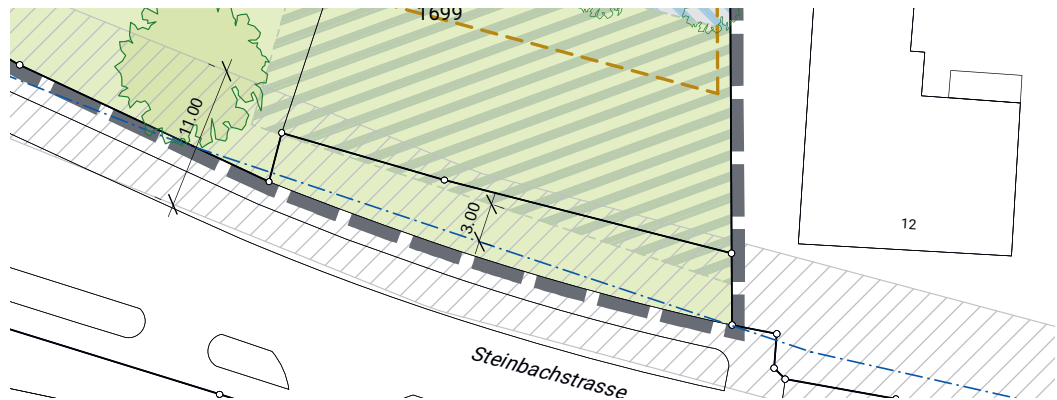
Ausschnitt Überbauungsplan mit Gewässerachse (blau gestrichelt) Aarbach und Minimalabstand sowie dem Gewässerraum (grau schraffiert)
